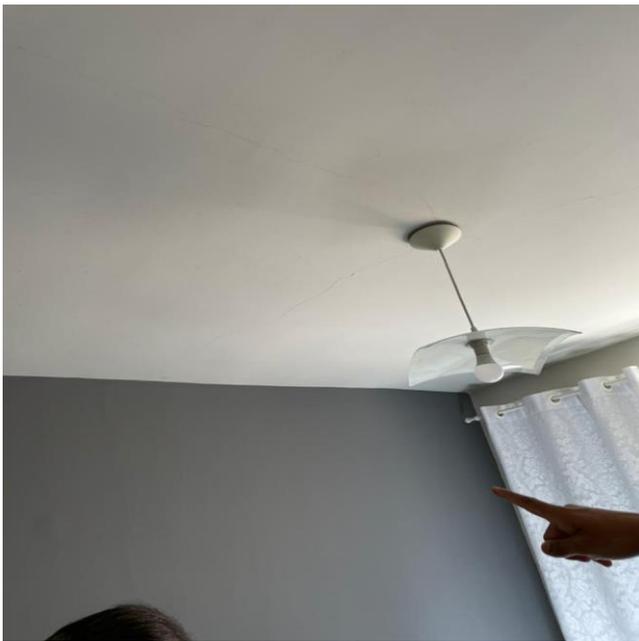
Apartamento 101 e do bloco A – Fissuras no teto.
